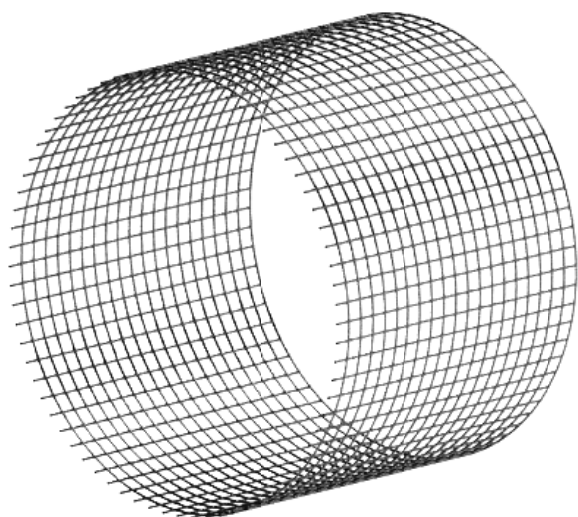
Внутренний силовой каркас крепи, собранной из модулей резино-воздушной армированной крепи, в выработке с круговым поперечным сечением
